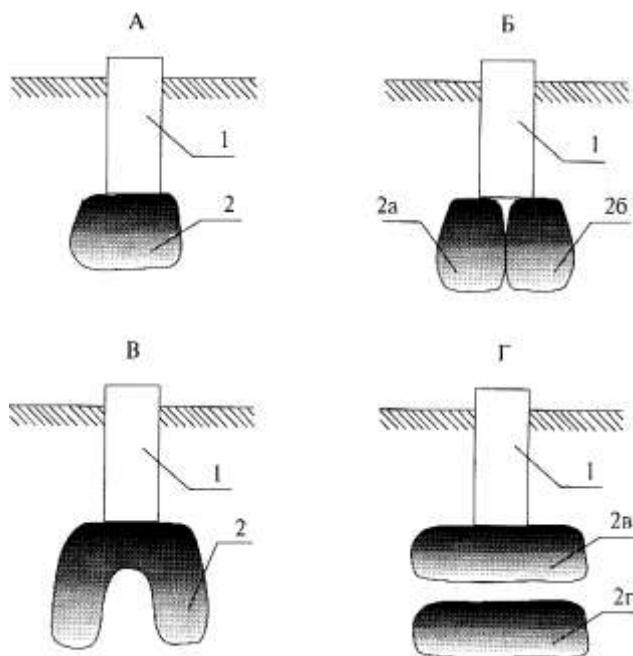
Схемы устройства оснований из закрепленного грунта:
